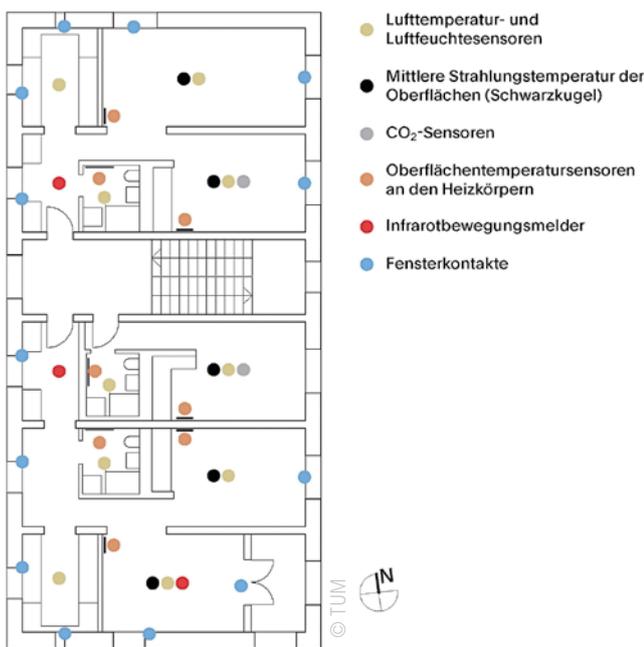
Anordnung der Sensoren im Grundriss
